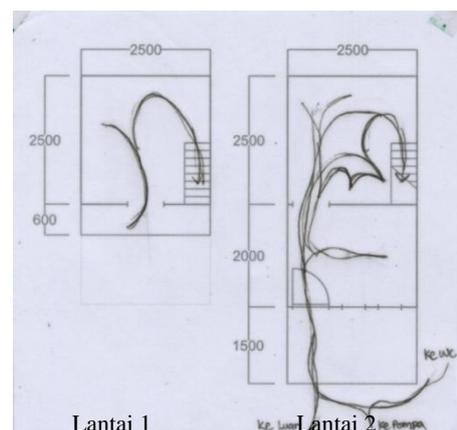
Denah lantai 2 rumah Mbak Sp.
